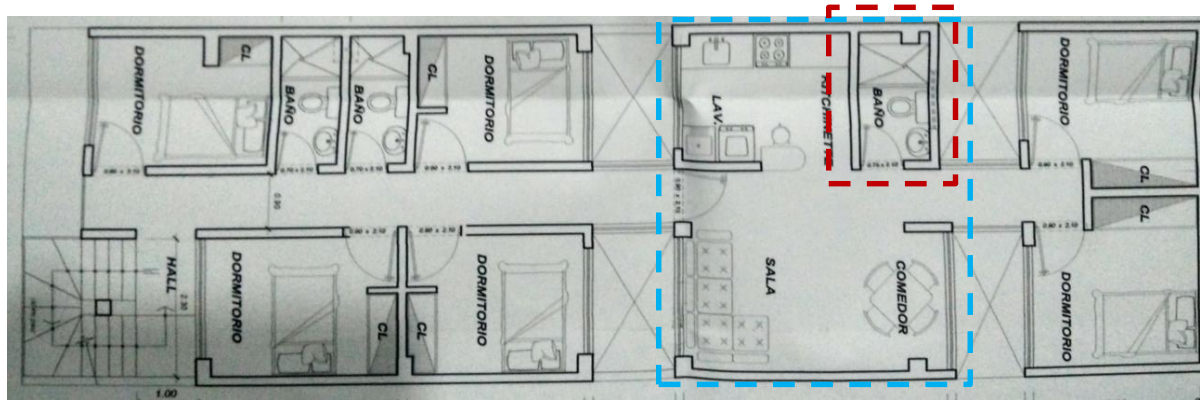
Planta del cuarto piso. Recuperado: Entrevista, 2017)
